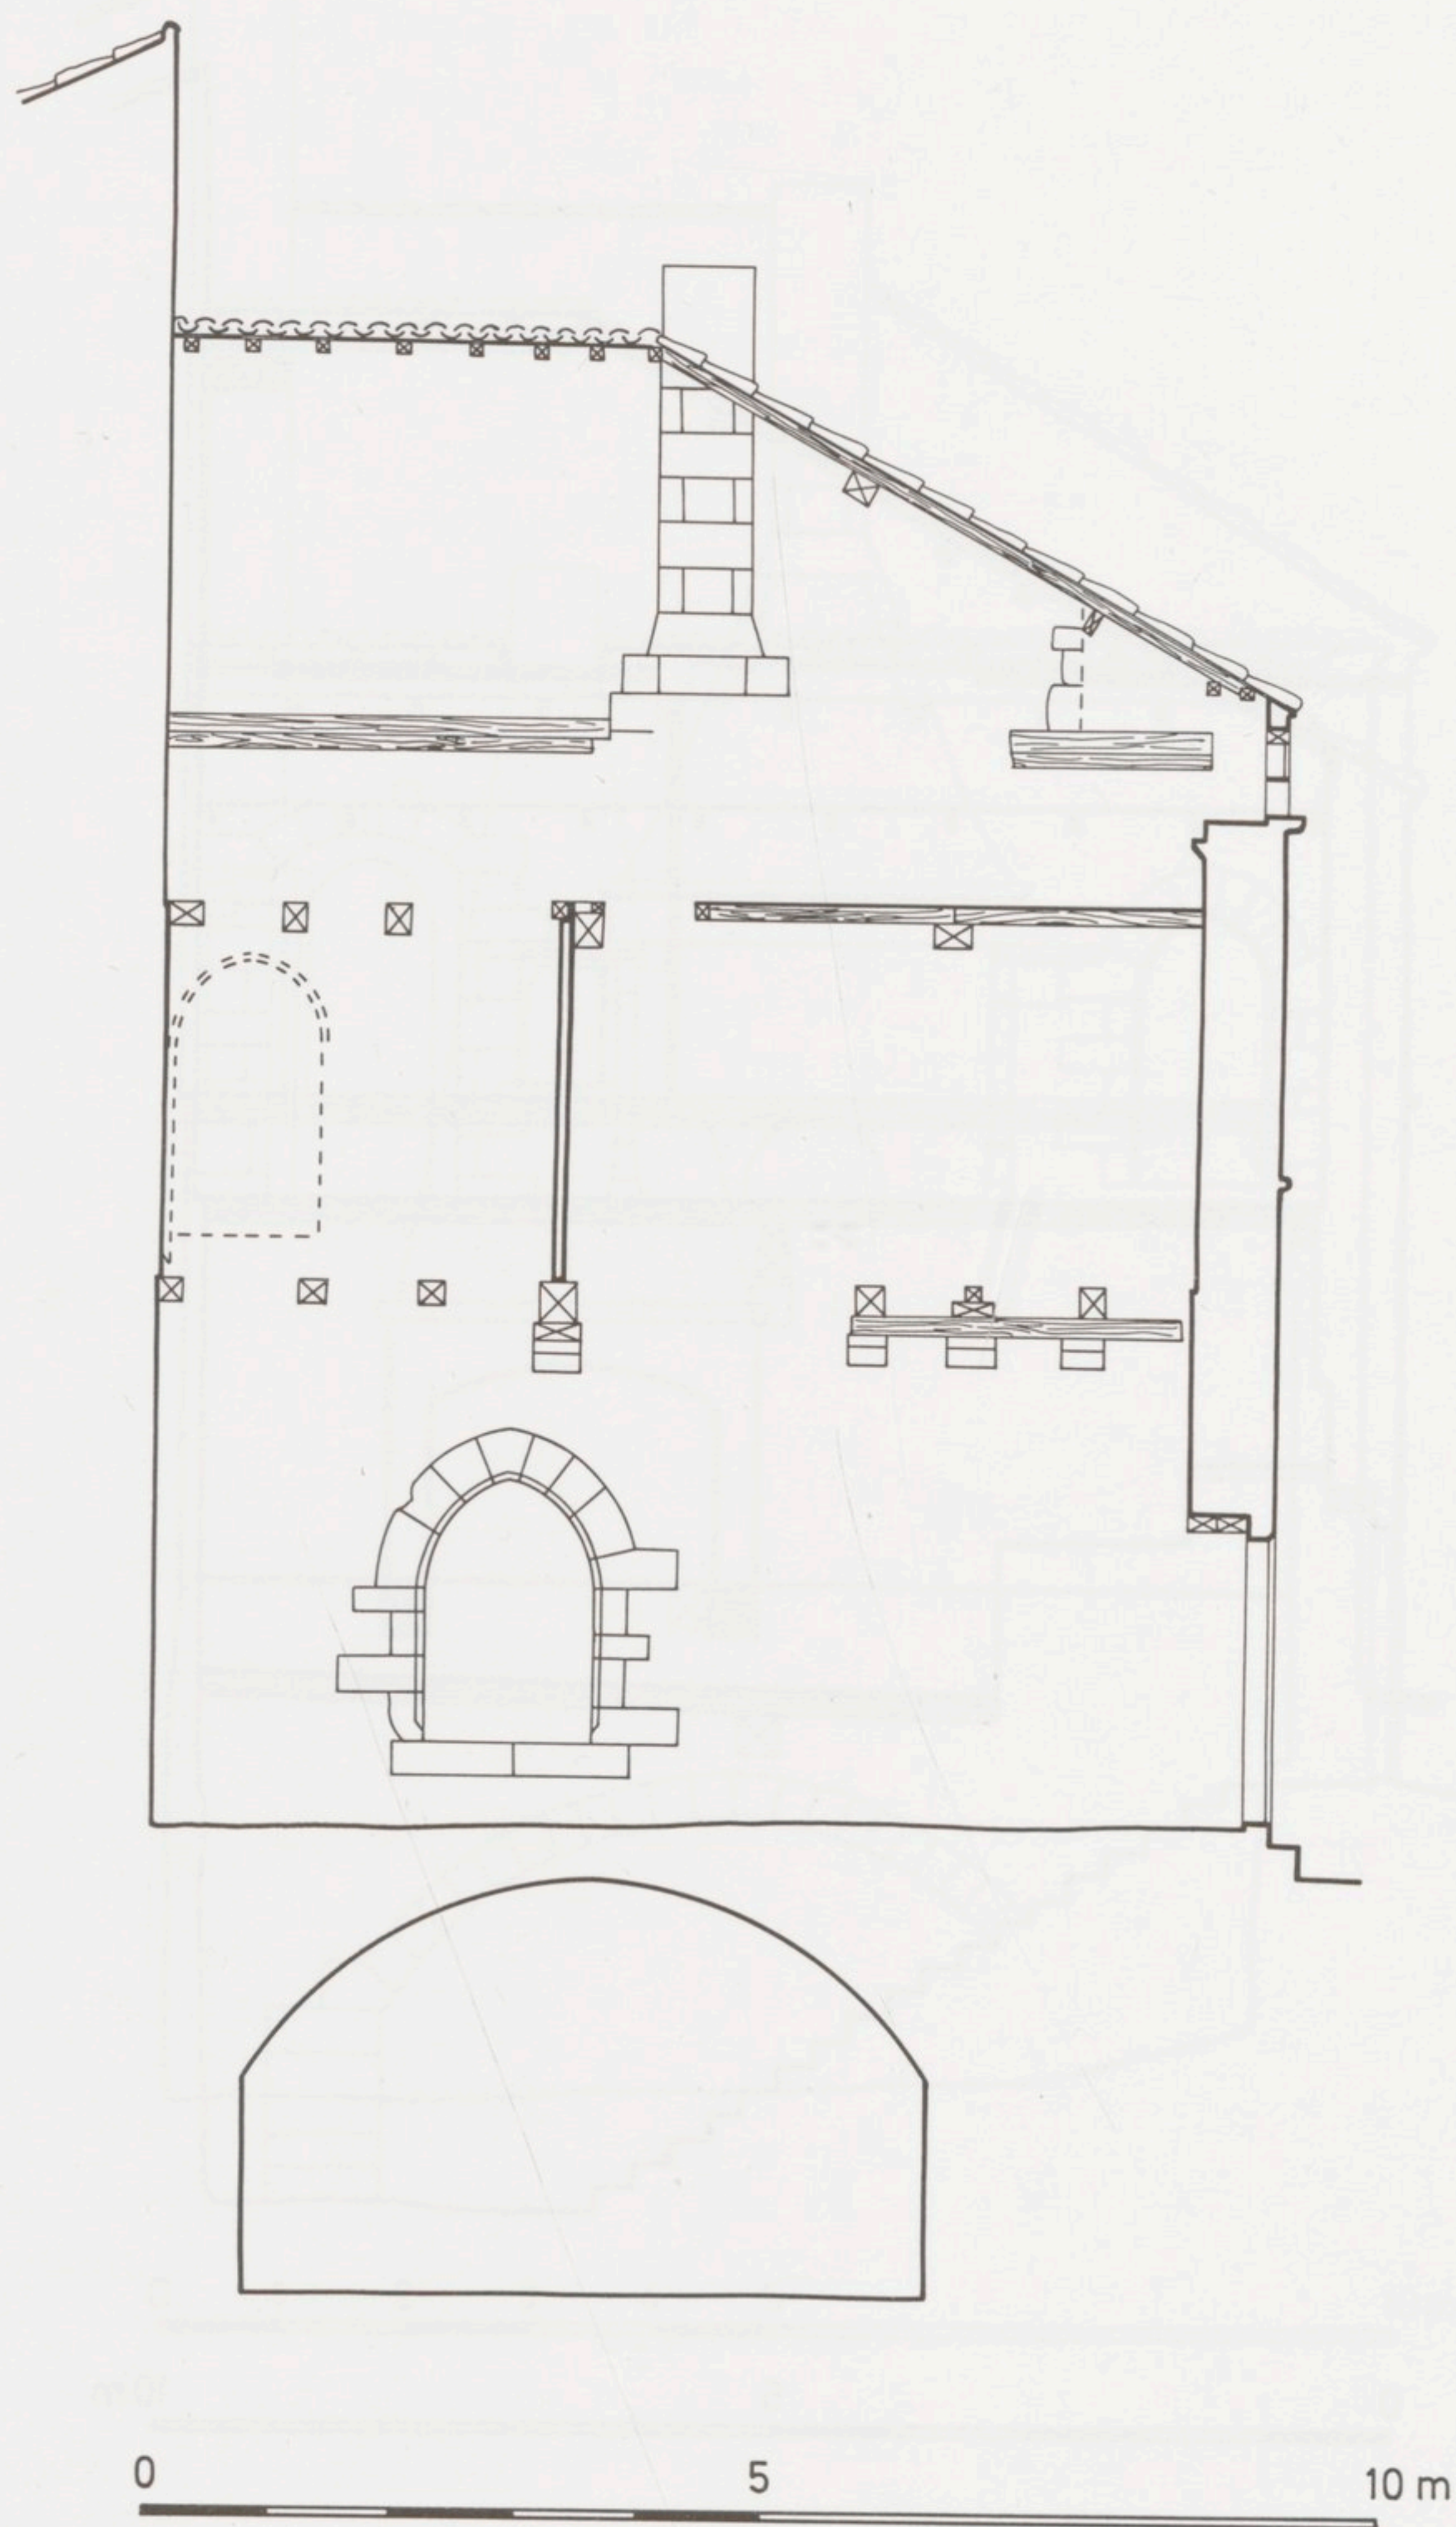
RUE BASSE, COUPE EST-OUEST ET ELEVATION SUD DU MUR DE REFEND, état actuel (Relevé P. Roques).
